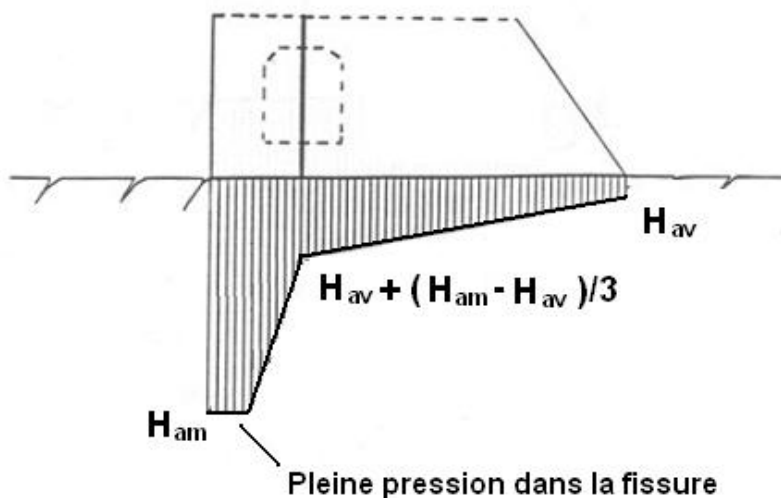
6 - Sous pressions si la fissuration n'atteint pas le rideau de drainage
